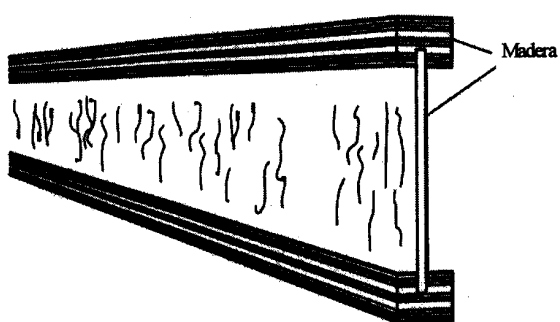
(a) (ii) Construcción de viga compuesta de madera típica
